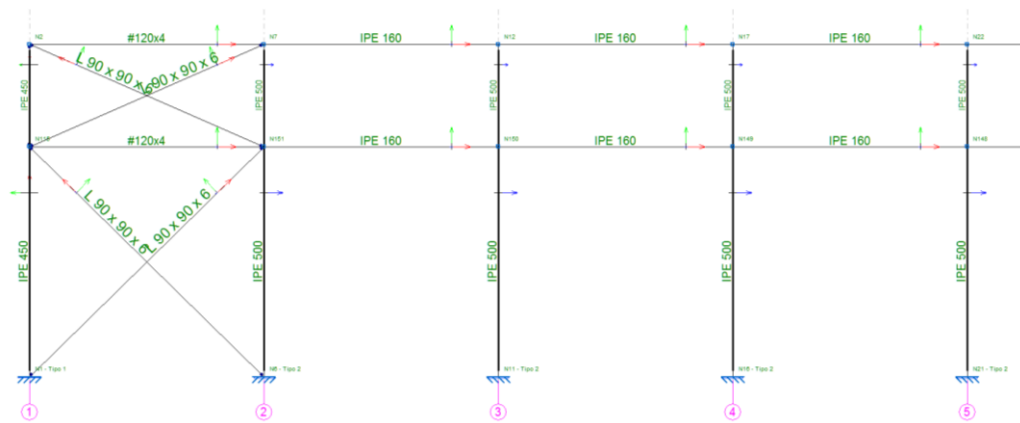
Arriostramientos laterales y viga perimetral con detalle de perfiles
